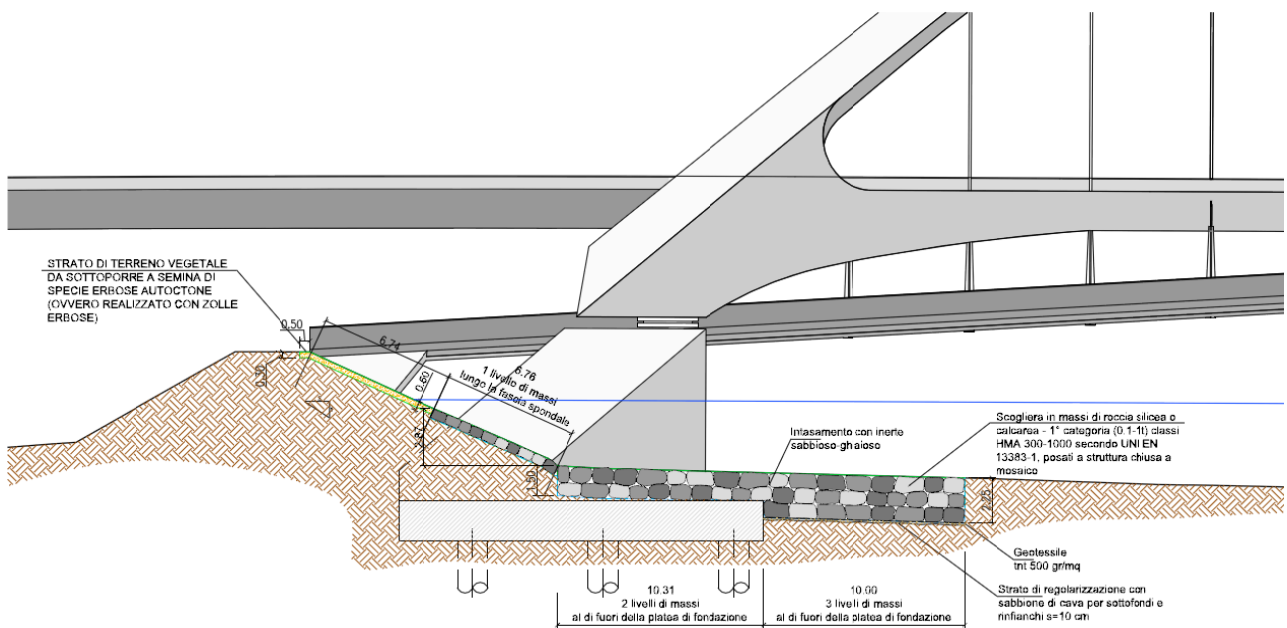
Attraversamento fiume Tevere - Opere di presidio in alveo – particolare
